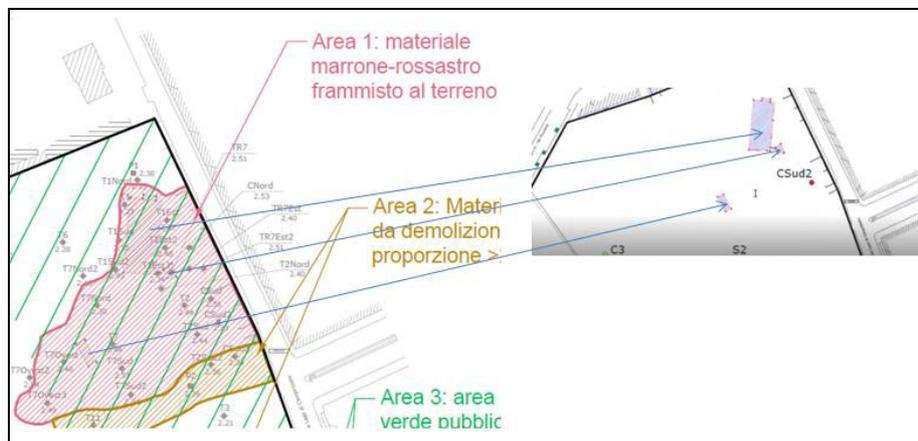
stralcio planimetrie 10 e 15 allegate al POB
